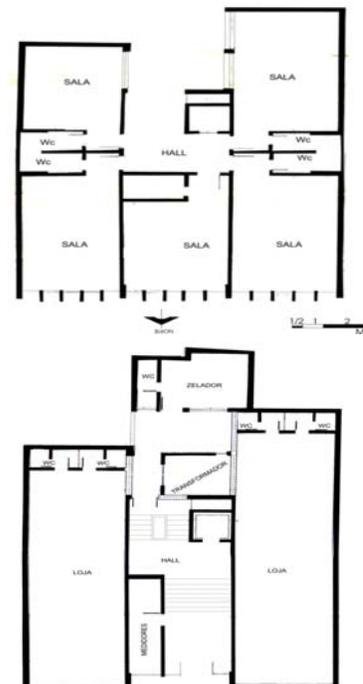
Edifício Teorema. Plantas baixas pavimentos térreo e tipo.
